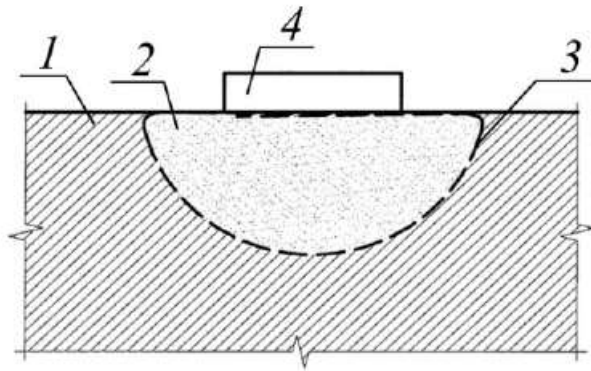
Армована по контуру фундаментна подушка: 1 – слабкий ґрунт; 2 – тіло подушки; 3 – тканий геотекстиль; 4 – фундамент
